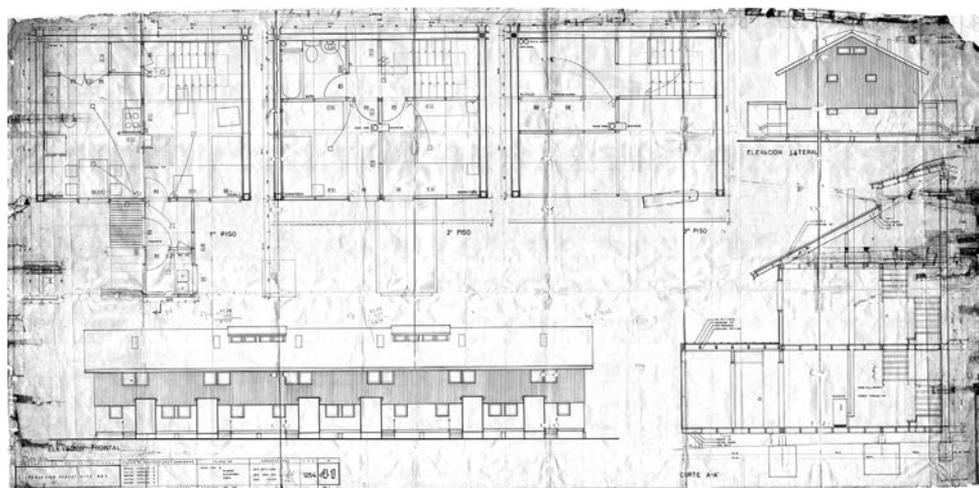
Planimetría de arquitectura Vivienda Tipo B 2 (DOM, 1961).
